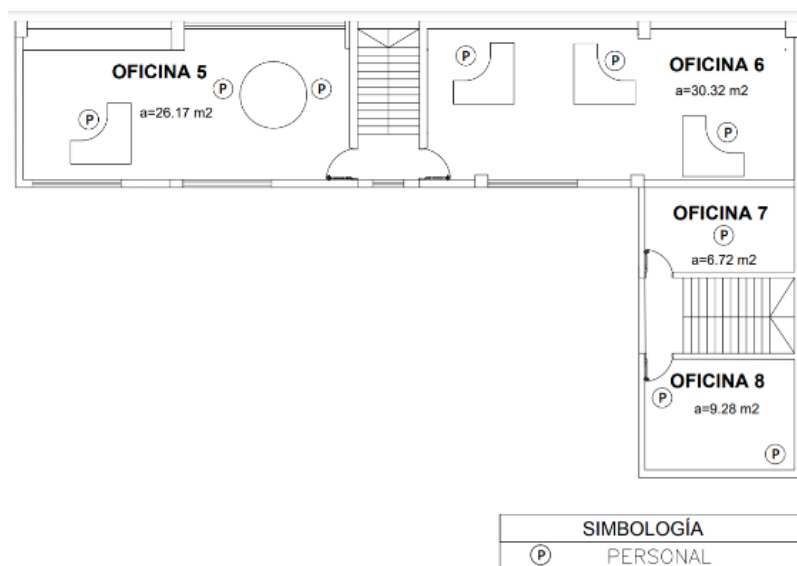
Área Administrativa- Planta Baja / Edificio Antiguo
